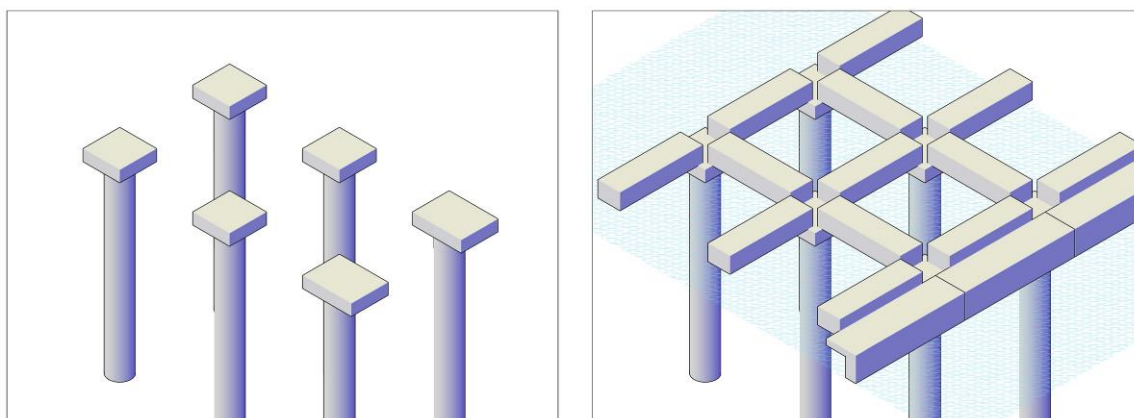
Schema di posizionamento dei pali e pulvini (a sinistra) e delle travi prefabbricate (a destra)
